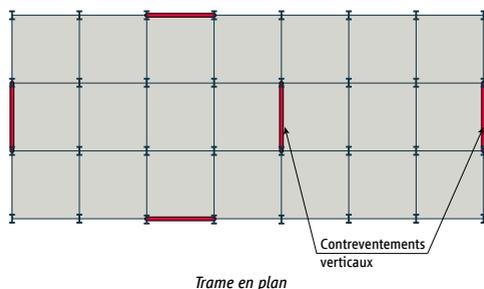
Configuration élançée avec 3 contreventements verticaux dans une direction
